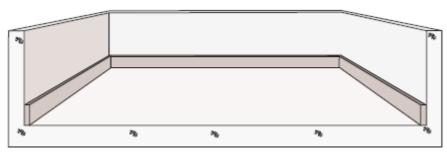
S'assurer que la dalle est propre, exempte de déchets et à niveau.
